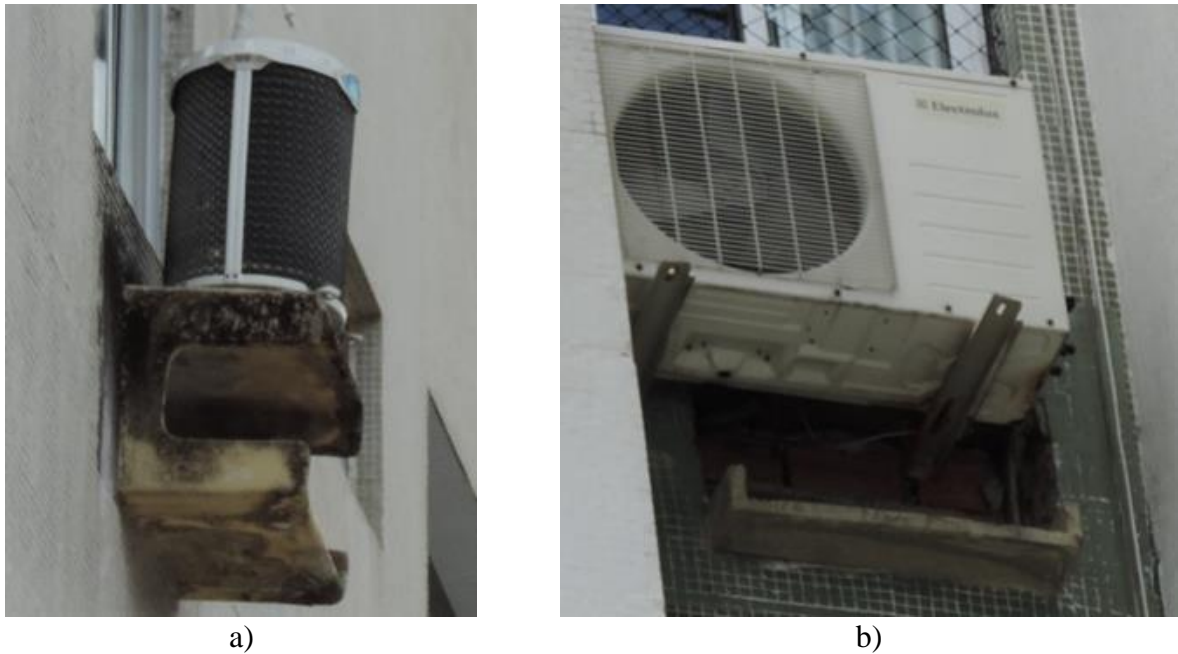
Uso inapropiado: a) esfuerzos desmesurados; b) infiltración en la fachada
